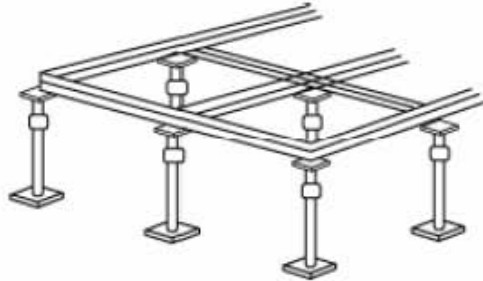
Instalación de canalizaciones bajo piso falso o elevado.
